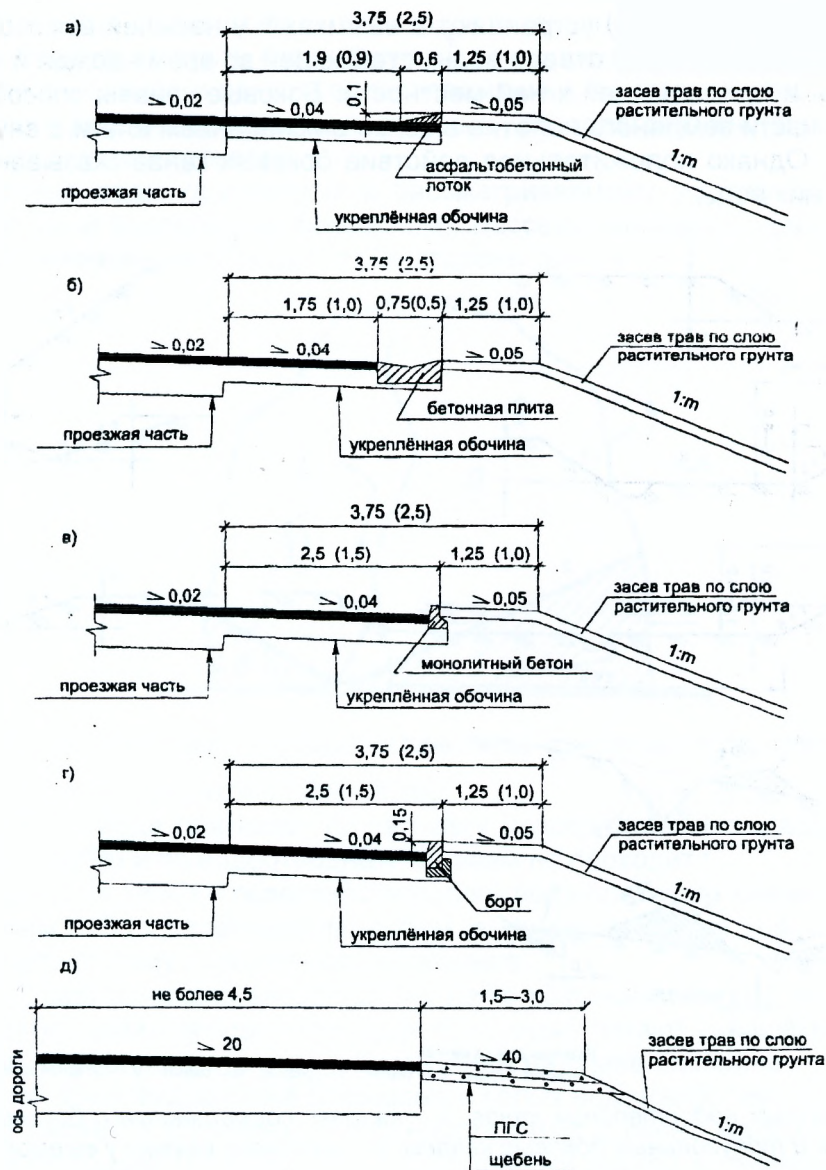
Водоотвод с проезжей части дорог прикромочными лотками: а – лоток непрерывного формования из асфальтобетона; б – то же, из монолитного бетона или бетонных плит; в – то же, из монолитного бетона или бетонных блоков; г – борт из бетонных бортовых блоков; д – щебеночные обочины
